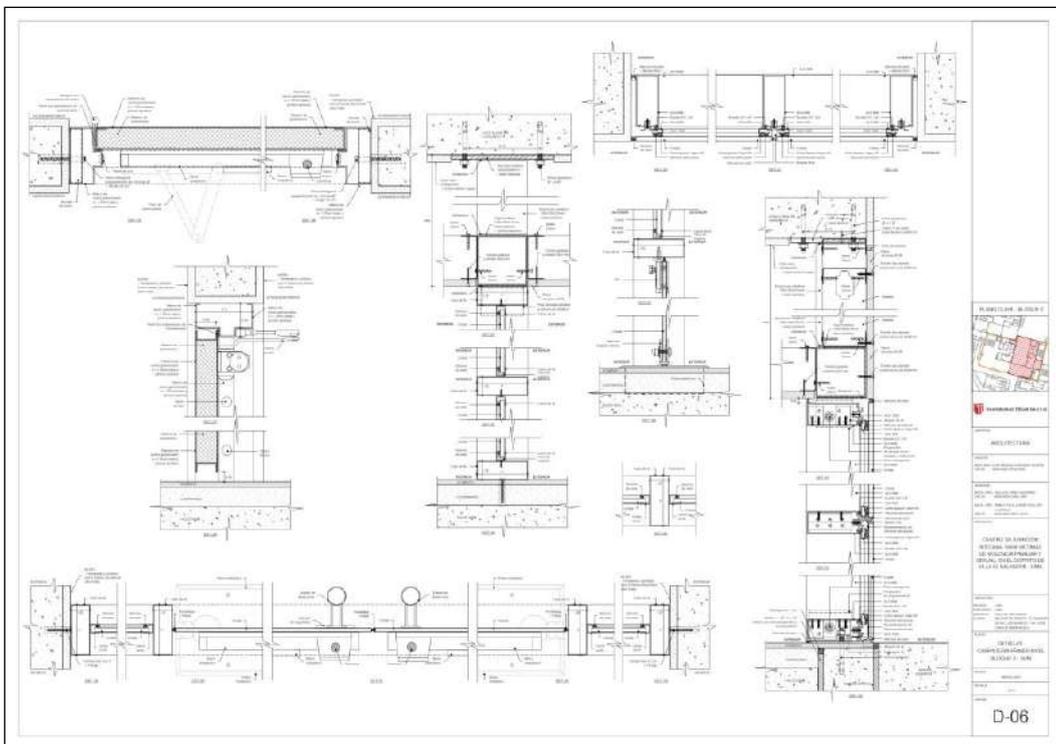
Detalles 3 de carpintería de zona SUM primer nivel – bloque 2.
